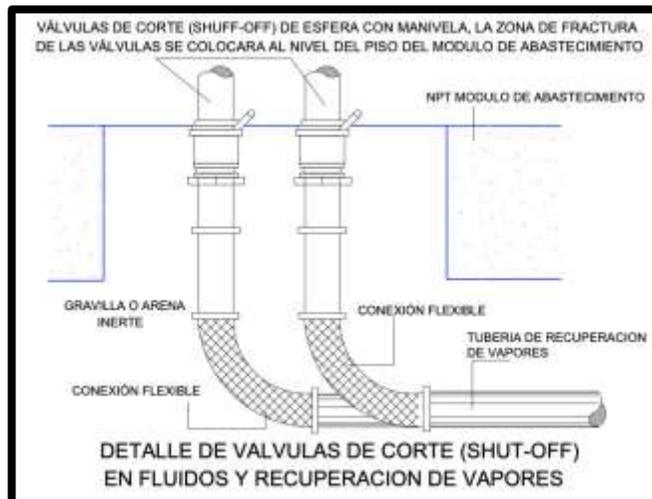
Detalle del sistema de válvulas de corte ([Plano M-1.1](#)).
